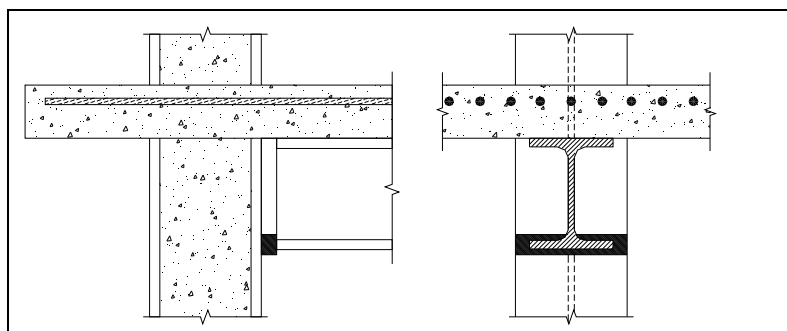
Ligação viga-coluna mista com chapa de contacto.
